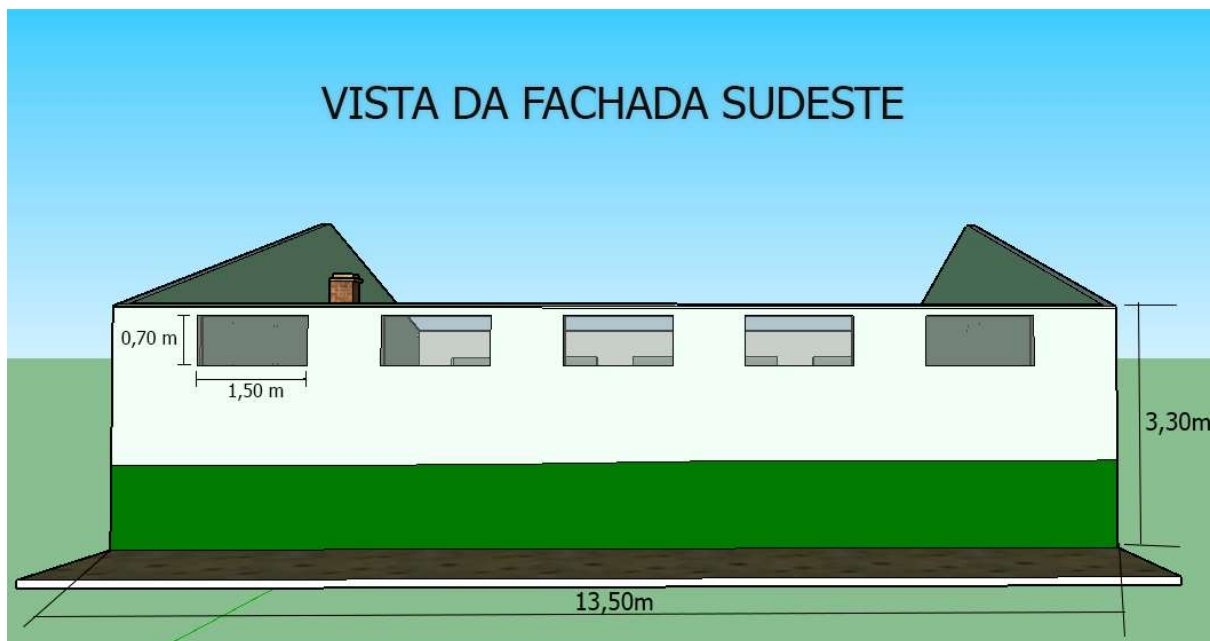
Características dimensionais da fachada sudeste do galpão.
